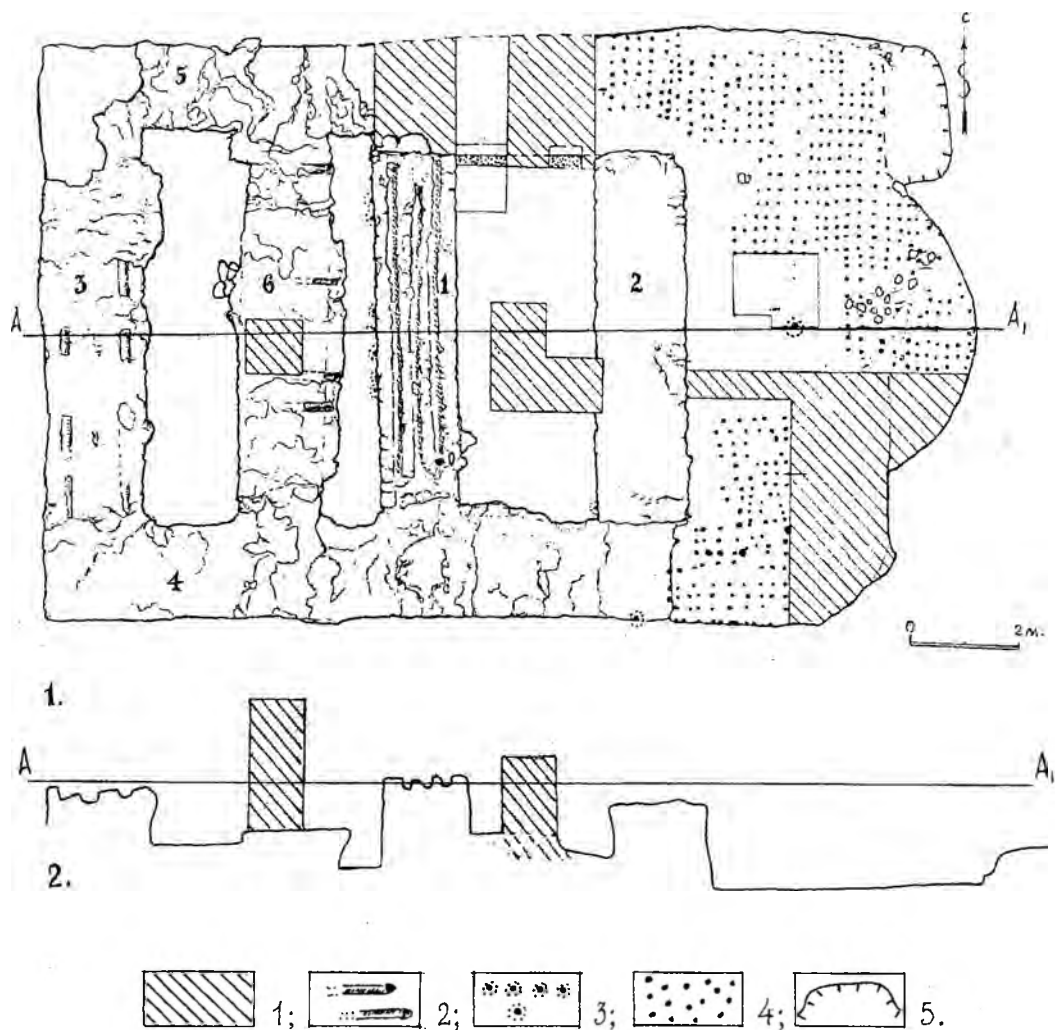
План и разрез фундаментов церкви св. Богородицы.
